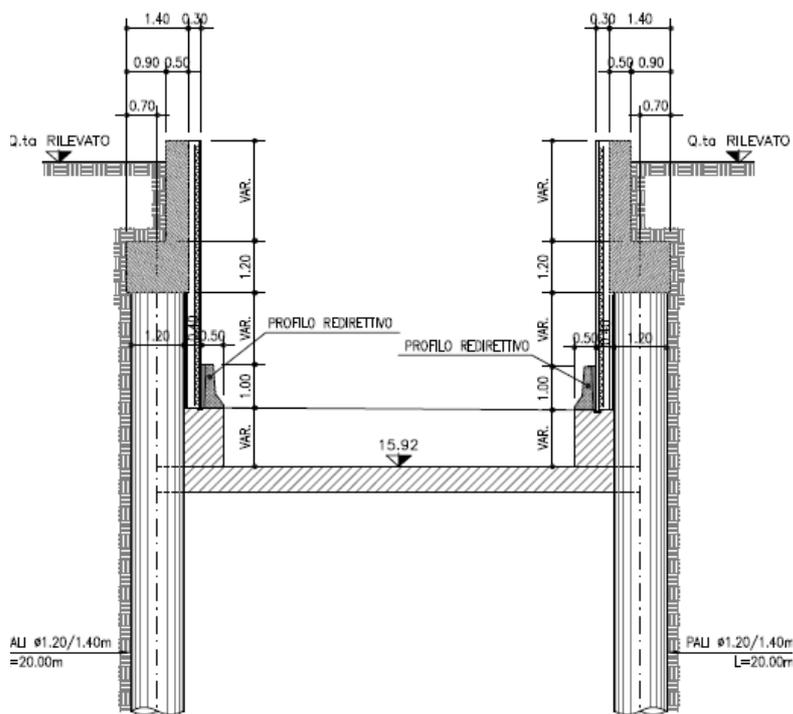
Sezione trasversale paratie fuori dall'impronta della piattaforma
